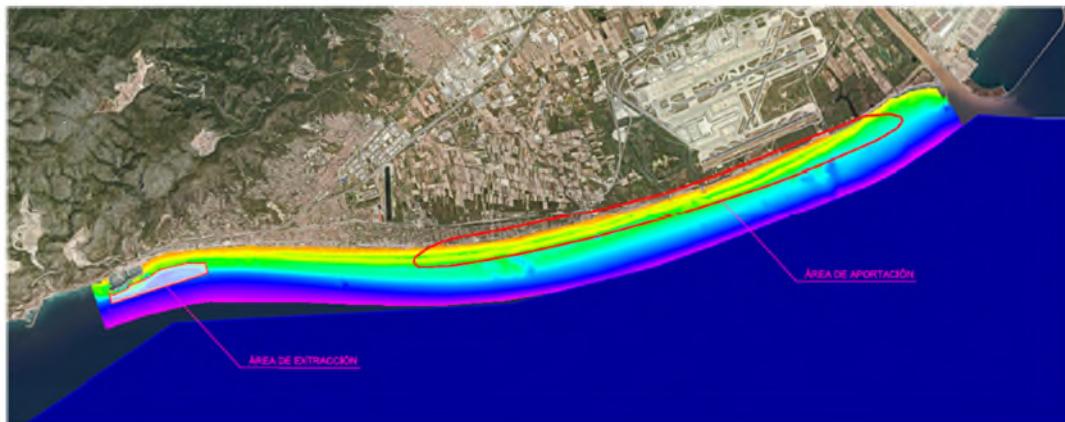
Ámbito del proyecto. Vista general de la zona de extracción y zona de aportación.
